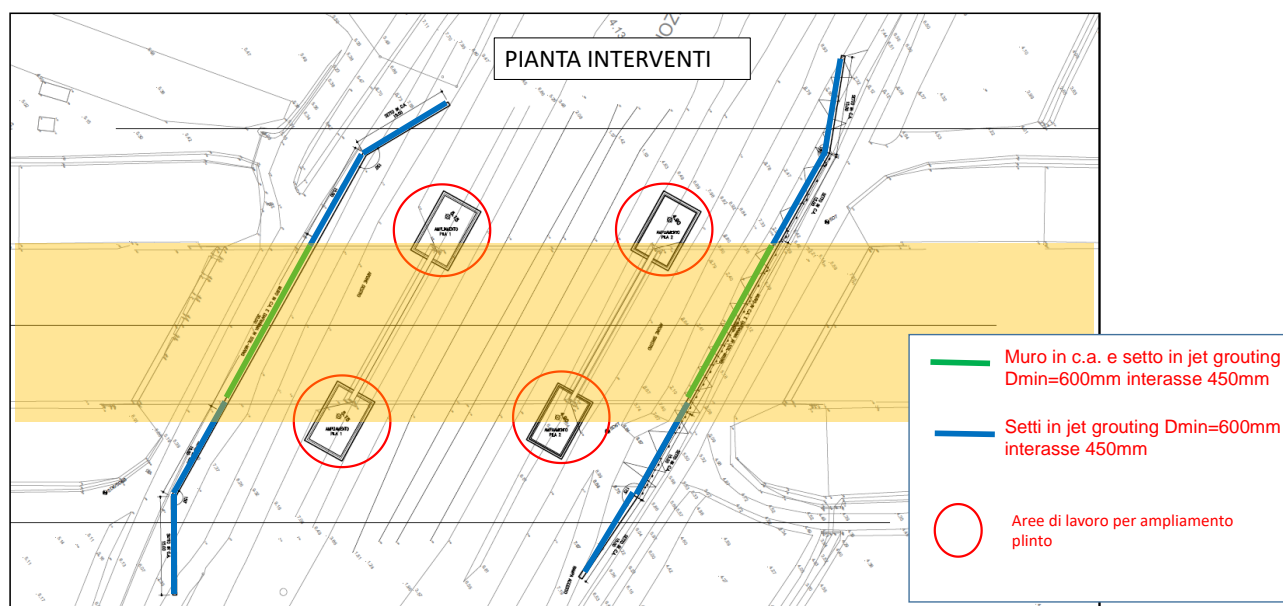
Ponte Canale Vigenzone – Pianta interventi
